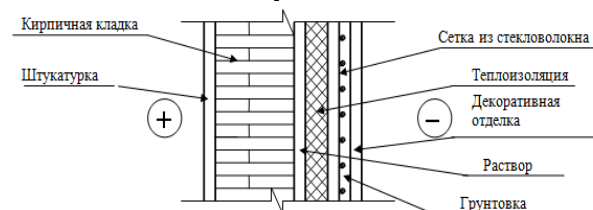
Конструкция системы утепления «мокрого типа»
